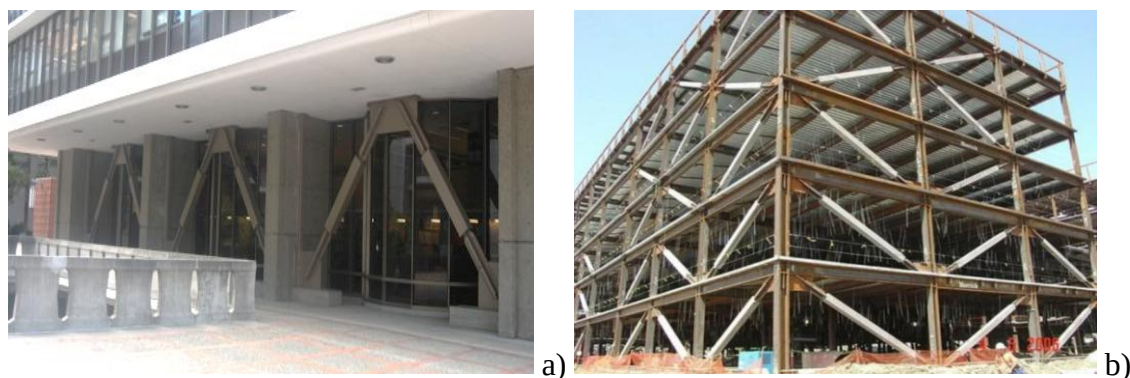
Contraventamento metálico *k-bracing*: a) (Sloan, 2006) e b) (Constrofacilitator, 2024).
